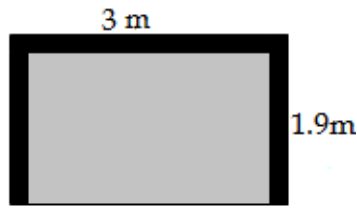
schéma de ferraillage de la dalle de compression.
